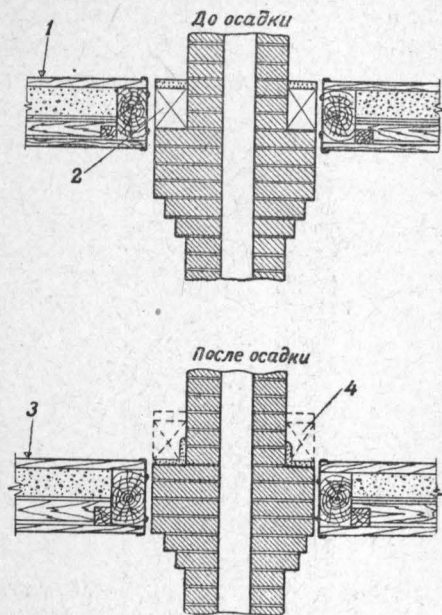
Горизонтальная разделка у дымового канала в междуэтажном перекрытии (до осадки перекрытия и после осадки):
